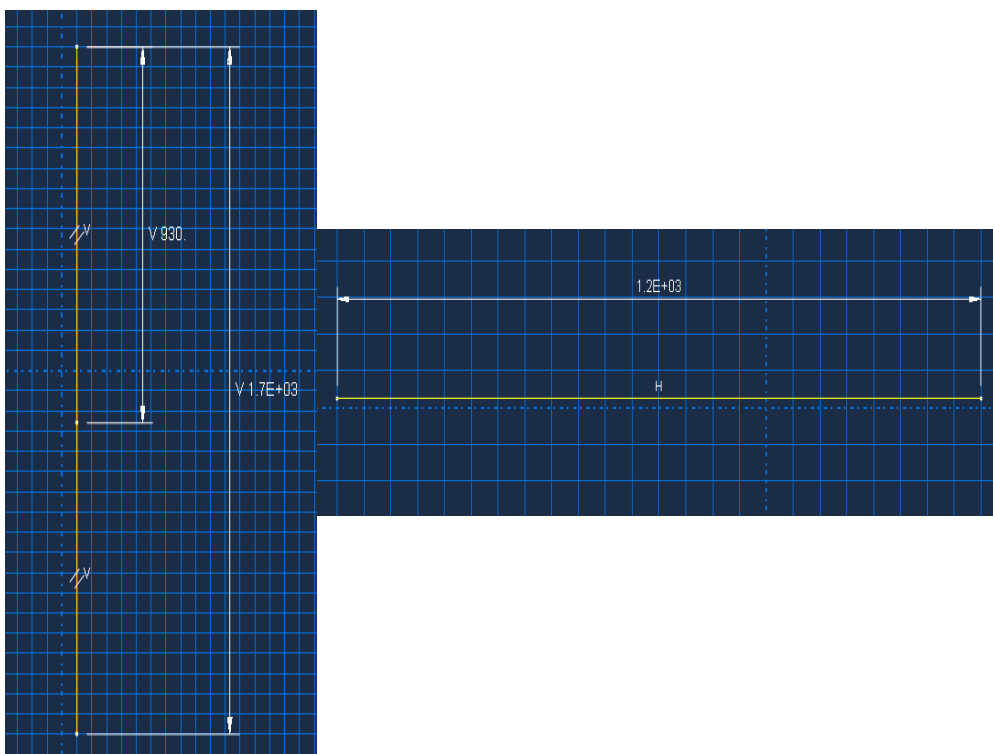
Boceto pilar (izquierda) y boceto viga (derecha). (Fuente: elaboración propia).
